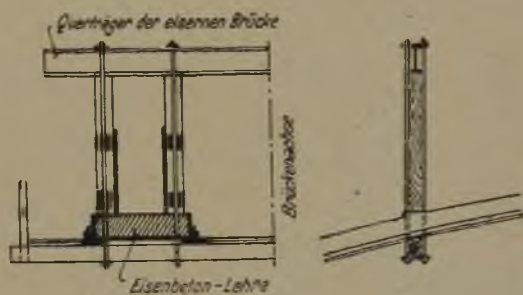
Ausführung mit an der vorhandenen eisernen Eisenbrücke aufgehängter Eisenbeton-Bogenlehre.
